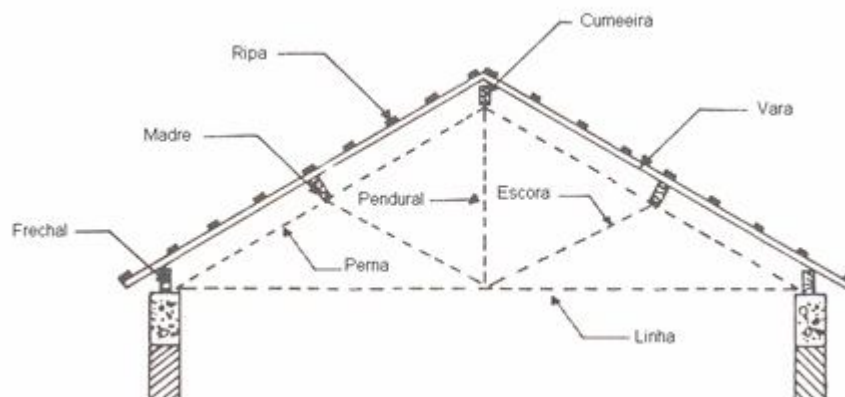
Estrutura de uma cobertura inclinada, em corte [36]
